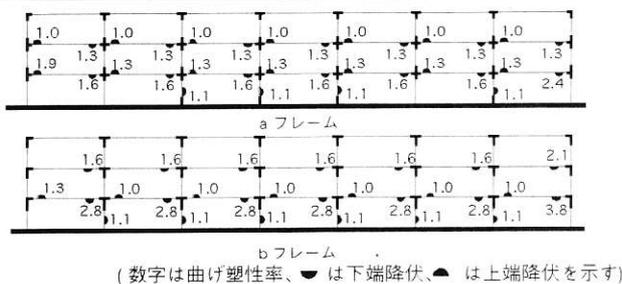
bフレーム1階中柱せん断破壊時のヒンジ形成状況
